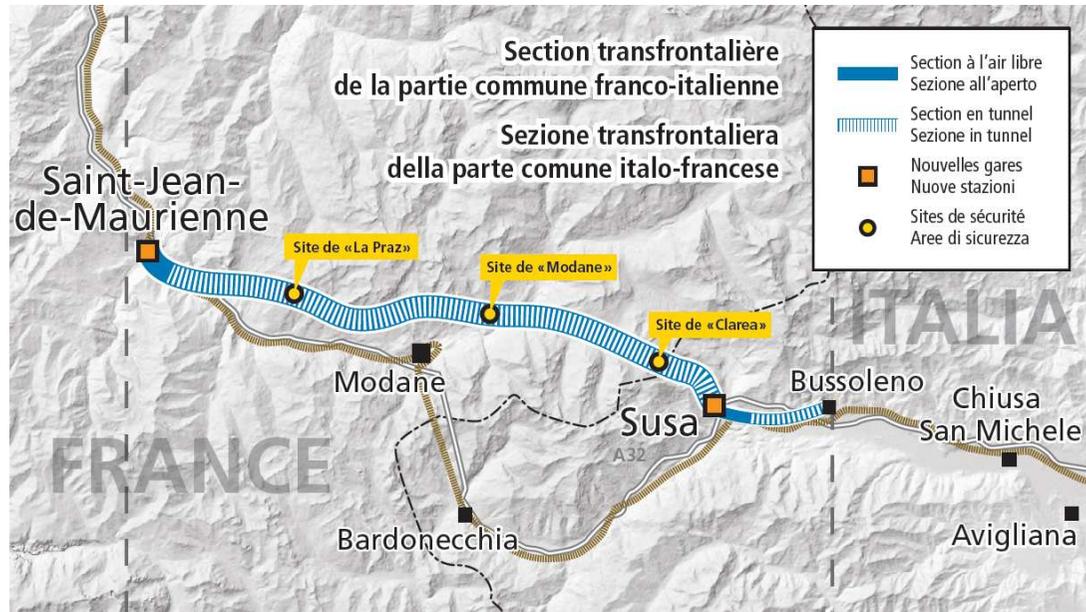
Planimetria della sezione Transfrontaliera – Allegato accordo Intergovernativo Italia - Francia
